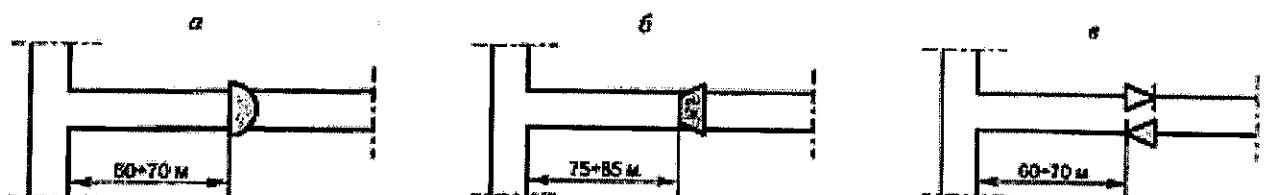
Схемы установки заслонов в конвейерной и вентиляционной выработках у сопряжений данных выработок с бремсбергами, уклонами, квершлагами
